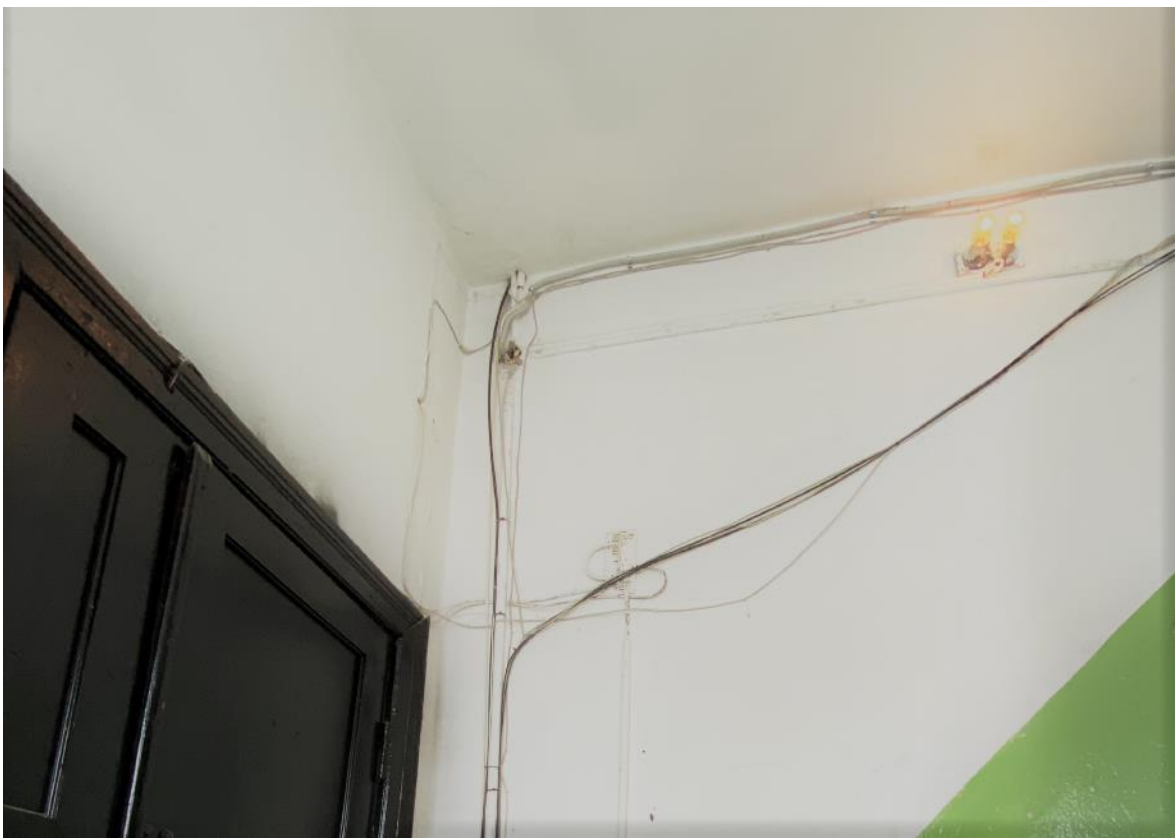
3-ий этаж лестничной клетки ЛК-2. Расположение электропроводки по стенам с нарушением способа прокладки. Отсутствует плафон светильника. Дата съемки: 11.04.2022 г. Автор: Прокофьев М.Ф.
